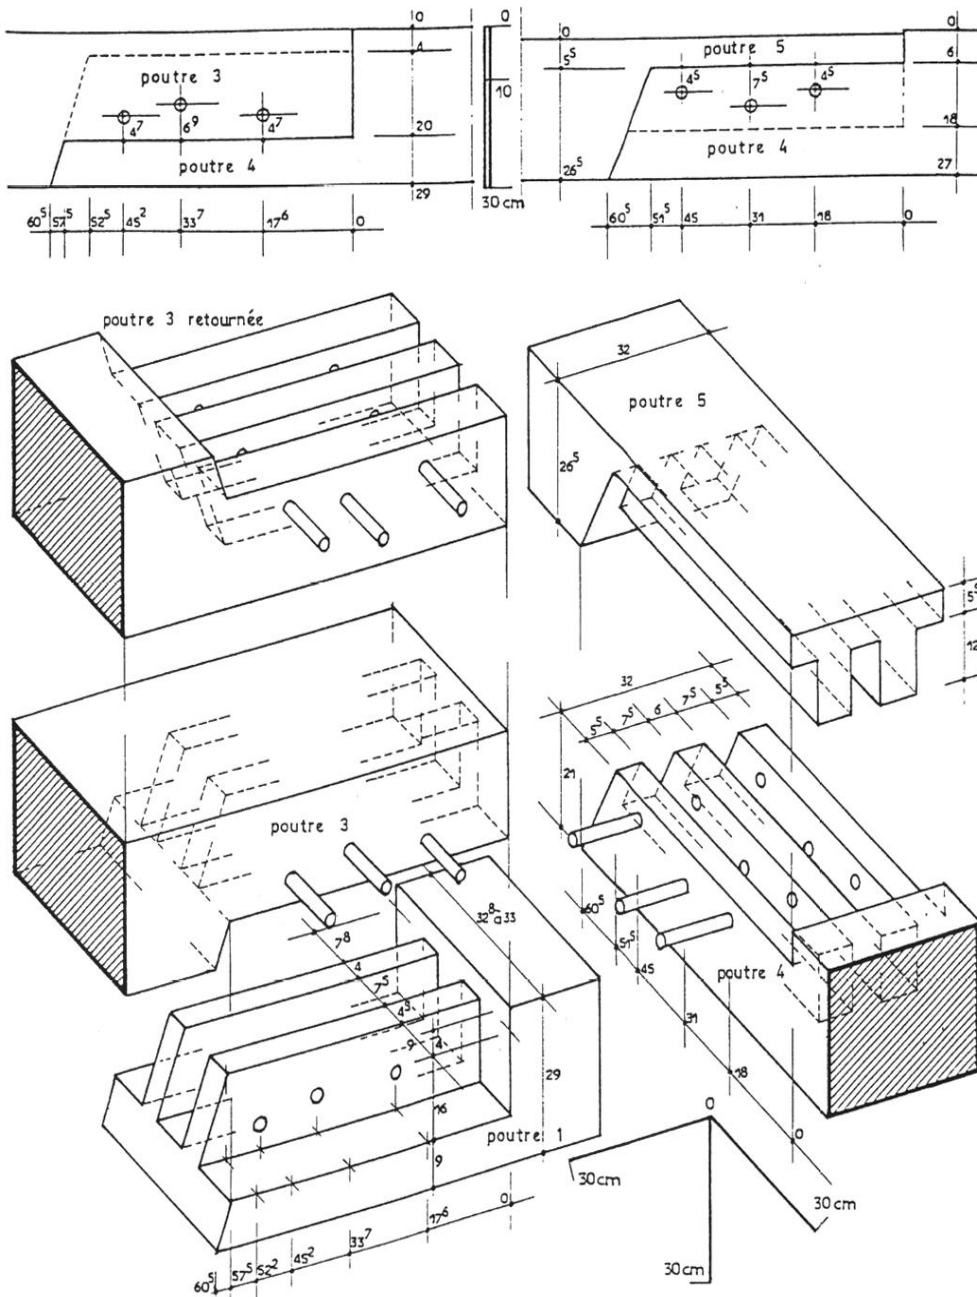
Rez-de-chaussée au nord. Grande salle- Cours de poutres- Assemblages. (Dessin H. Rezza Doc. C.R.M.H.)
